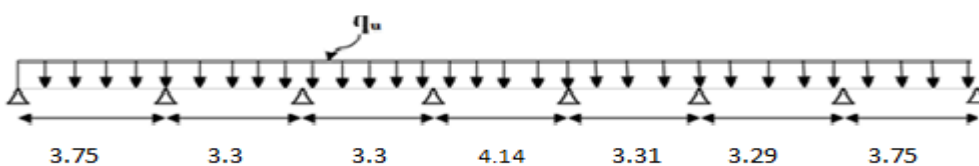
Schéma statique de la poutrelle a sept travées.
